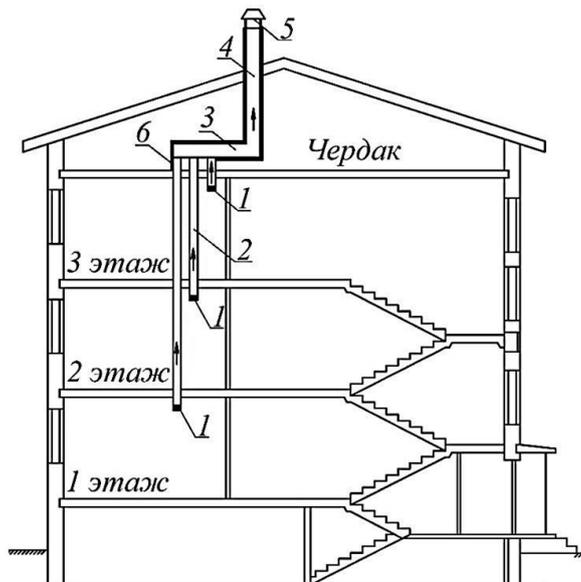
Схема канальной системы вытяжной вентиляции с естественным побуждением: 1 – вытяжная решетка; 2 – вертикальный канал; 3 – горизонтальный утепленный канал; 4 – утепленная вытяжная шахта; 5 – вытяжной зонтик; 6 – утеплитель
